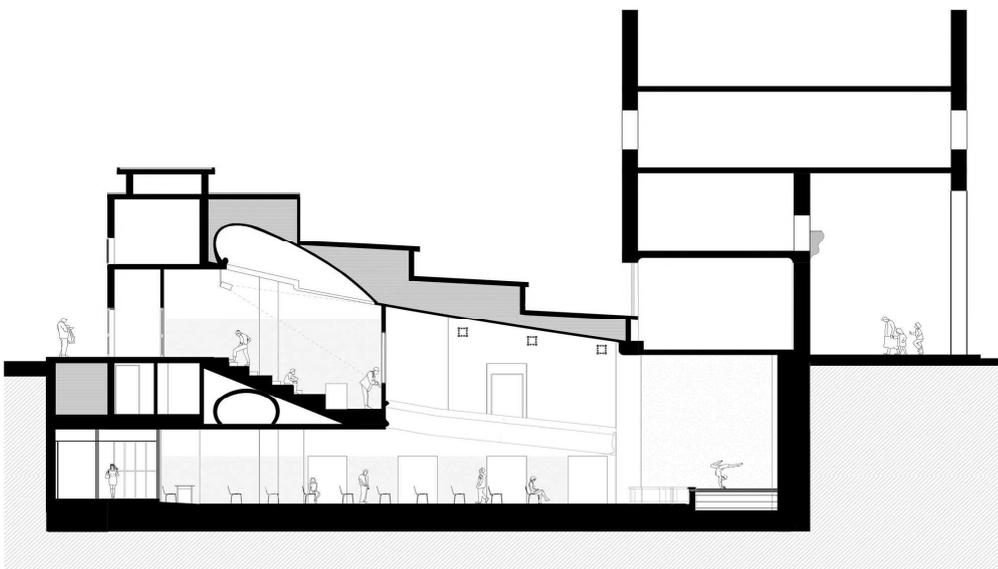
Planimetrie di progetto del caffè Muller dello studio Plac, sezione, 2017
